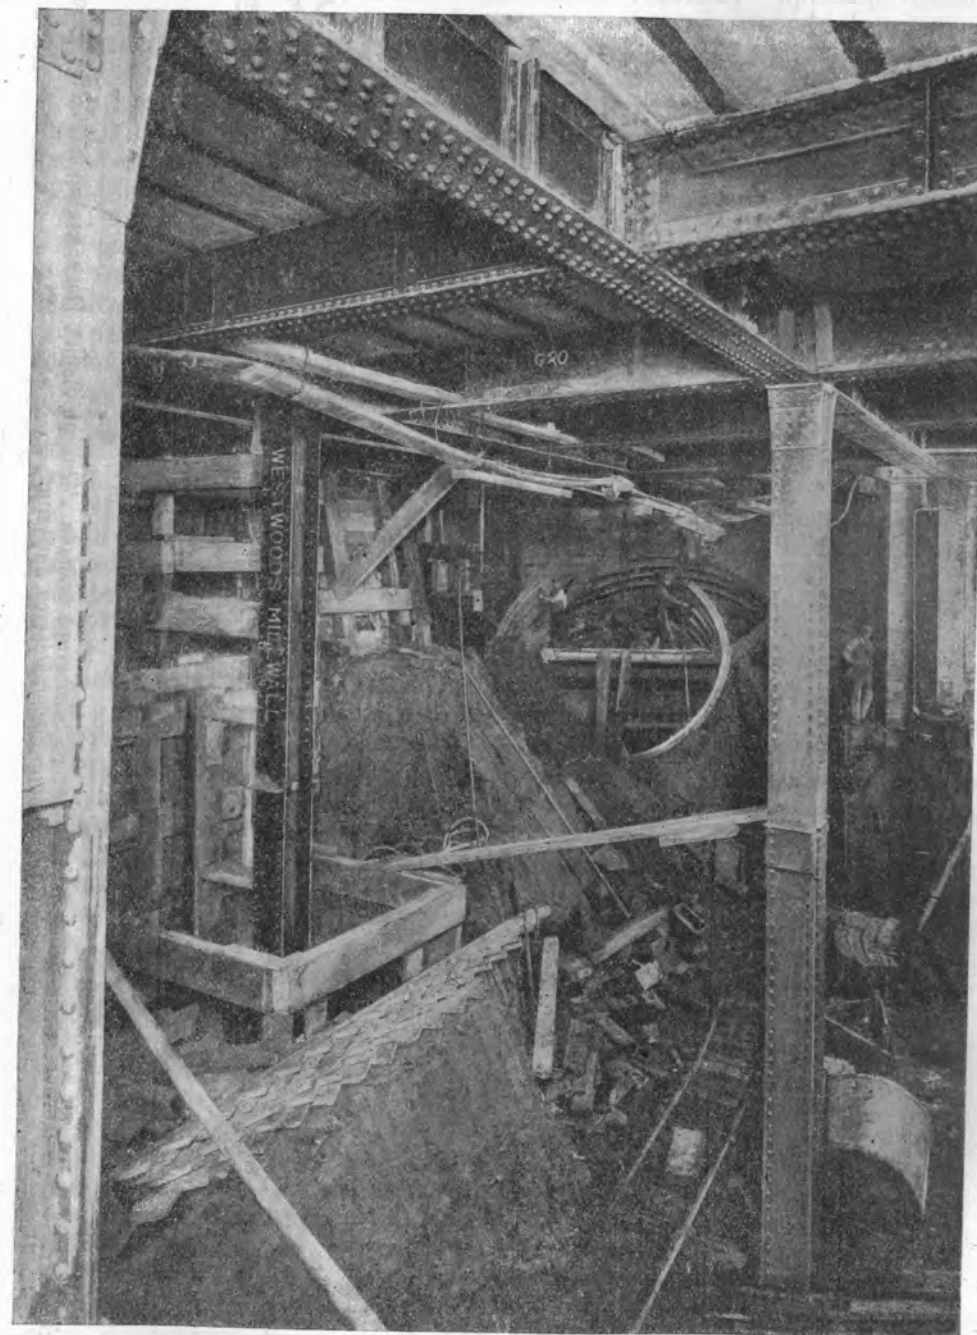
Момент выборки ядра при сооружении подземным путем несущих конструкций стен, колонн и перекрытия вестибюля станции. Виден «пилот-тоннель».
